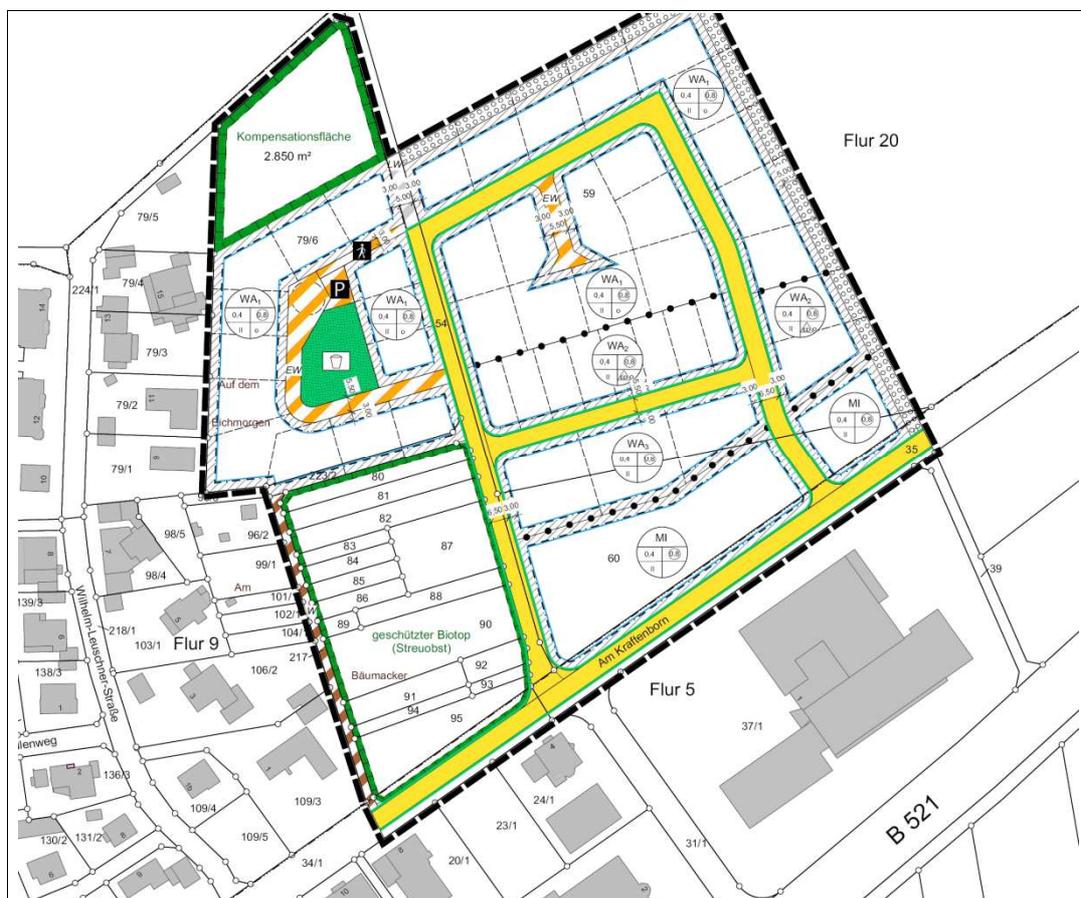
Bebauungsplan Nr. 20 Eichmorgen.
